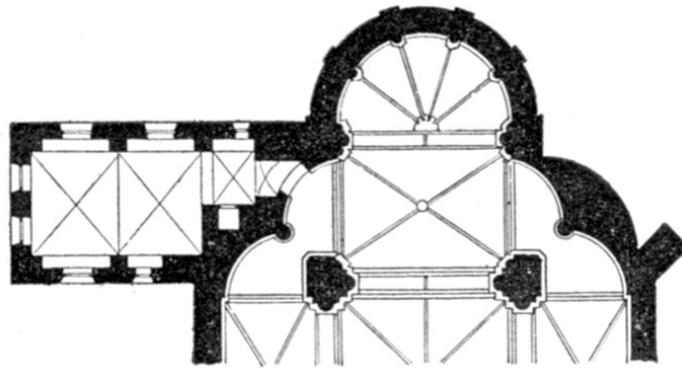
Jetziger Chorgrundriss mit dem neuen Sakristei-Anbau
